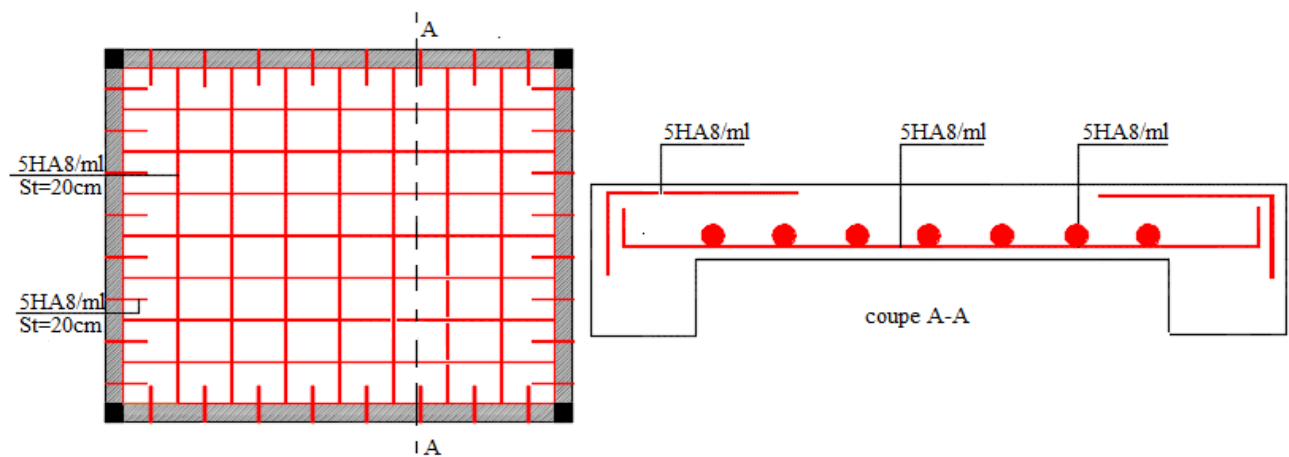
Schéma de ferrailage de la dalle pleine de locale des machines.
